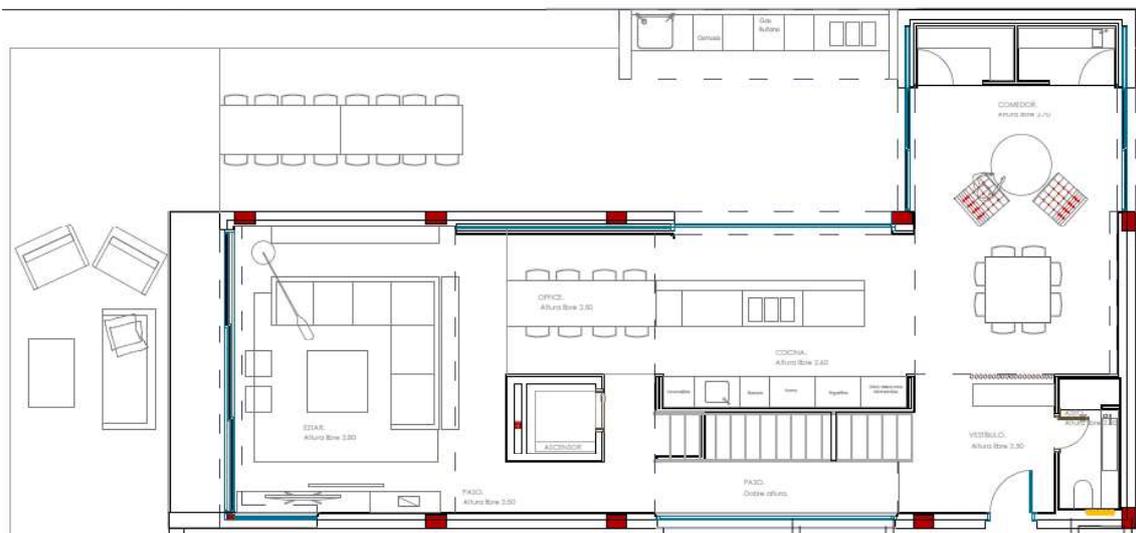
Plano de la Planta Baja de la vivienda. Vista: En Planta
